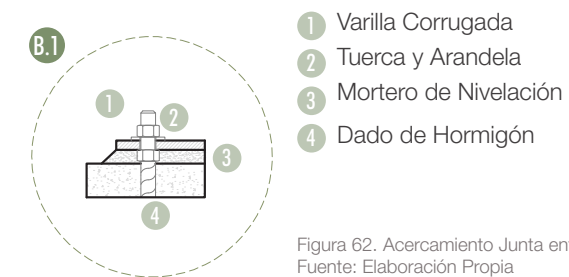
Acercamiento Junta entre Dado de Hormigón y Placa Metálica
